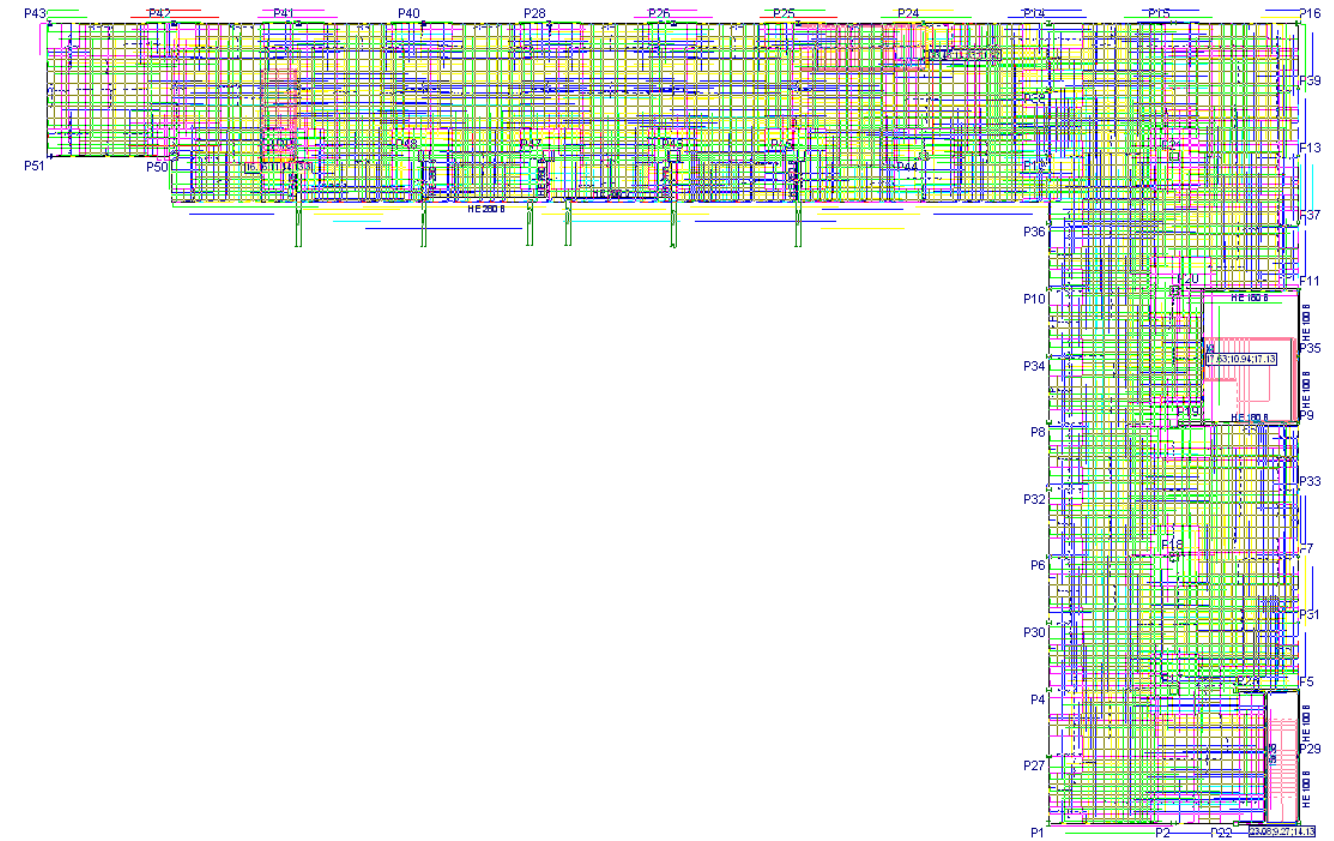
Disposición en planta del forjado reticular con primera propuesta de armadura. Fuente: Propia
